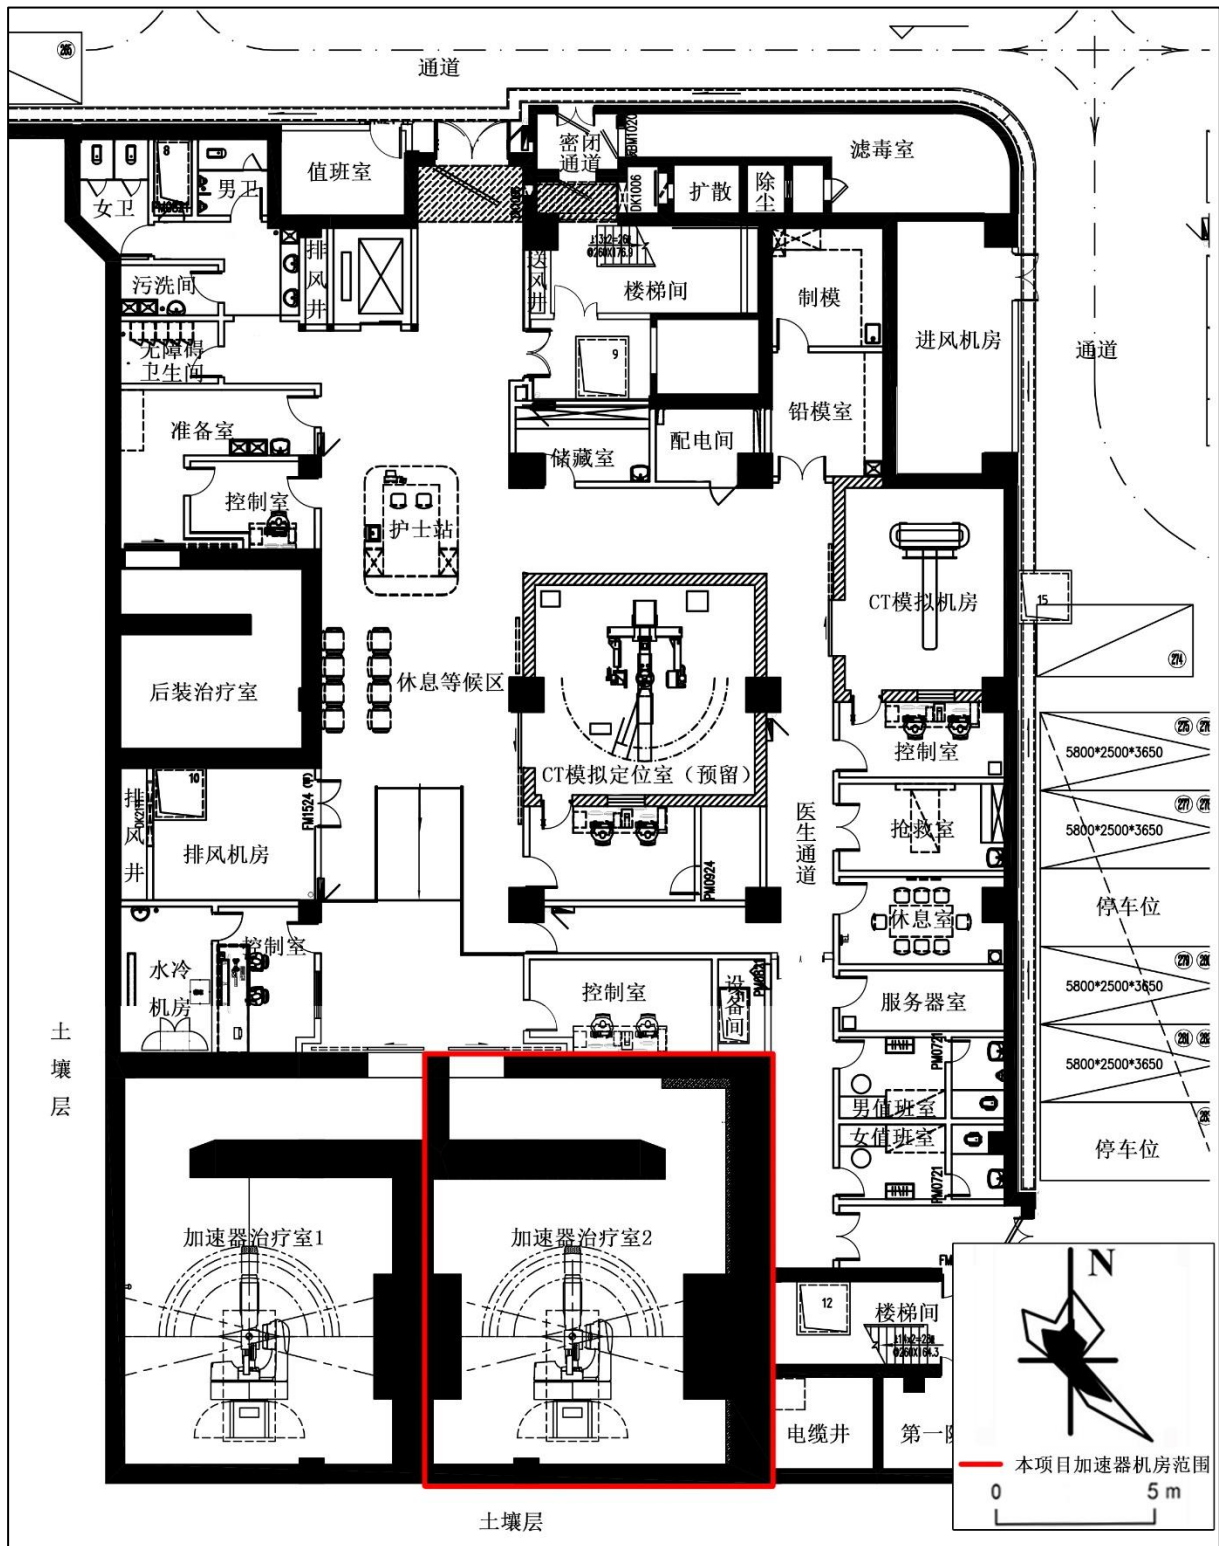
福建省立医院 6 号楼负 3 楼局部平面图
